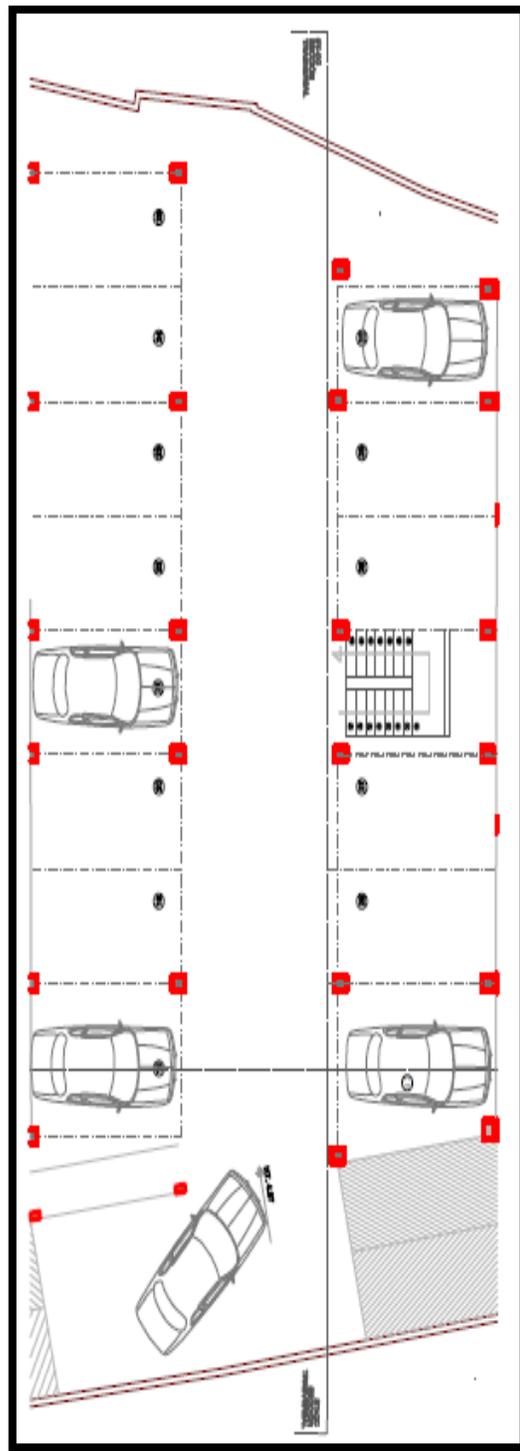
Plano Arquitectónico "Primer Planta Parquaderos"
